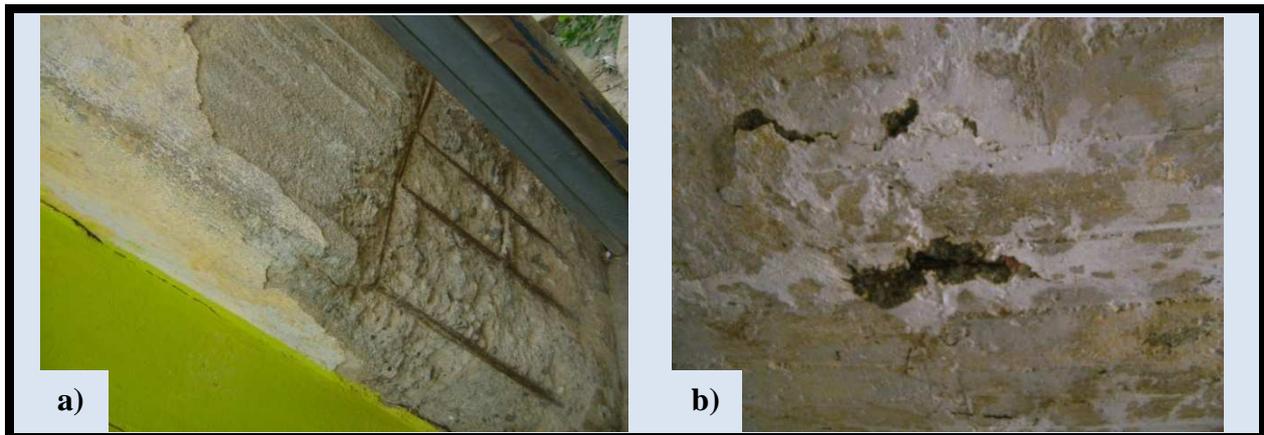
Photos de la corrosion des barres d'acier ; a) Le poteau, b) La dalle pleine, source : l'auteur.
